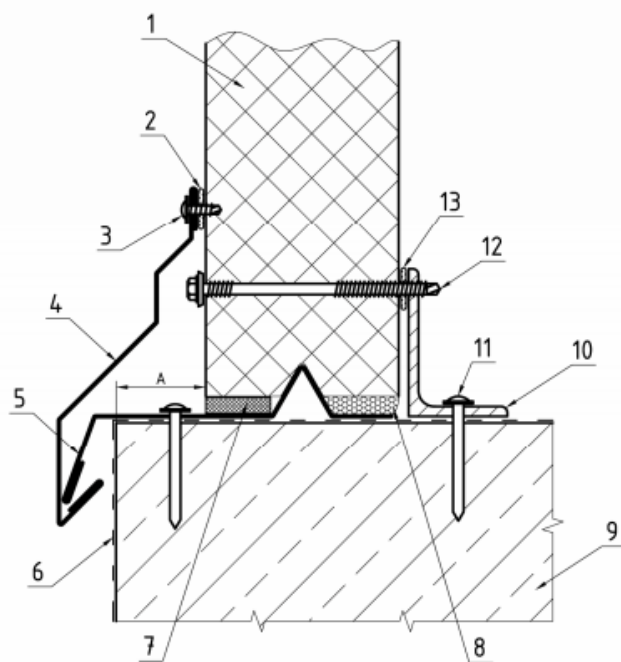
Внутренняя гидроизоляция по кирпичной стене
